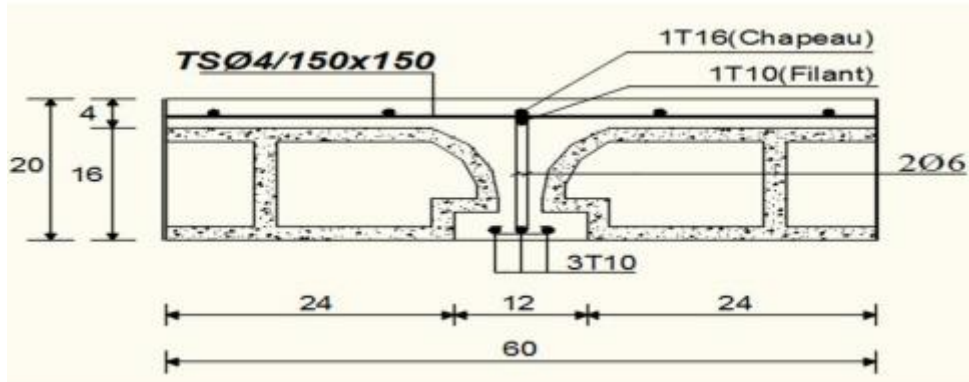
Coupe transversale d'un plancher à corps creux.
